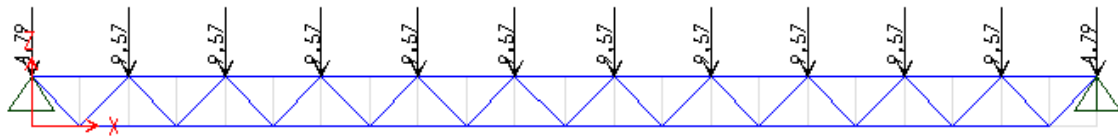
Geometria e carregamento (kN) para Treliça Warren com vão de 15 metros
